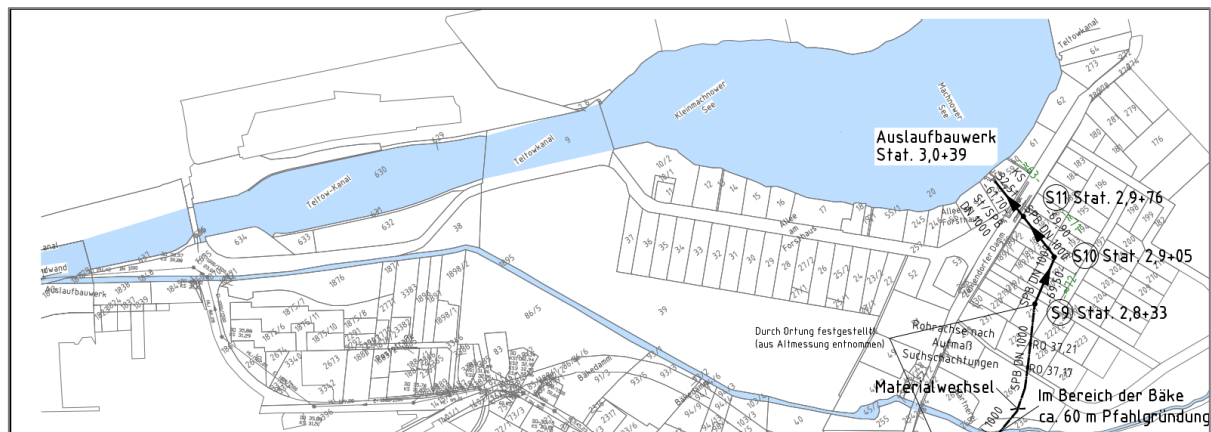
Lageplan Ableiter II und Auslaufbauwerk in den Machnower See, eingeordnet (BWB)
